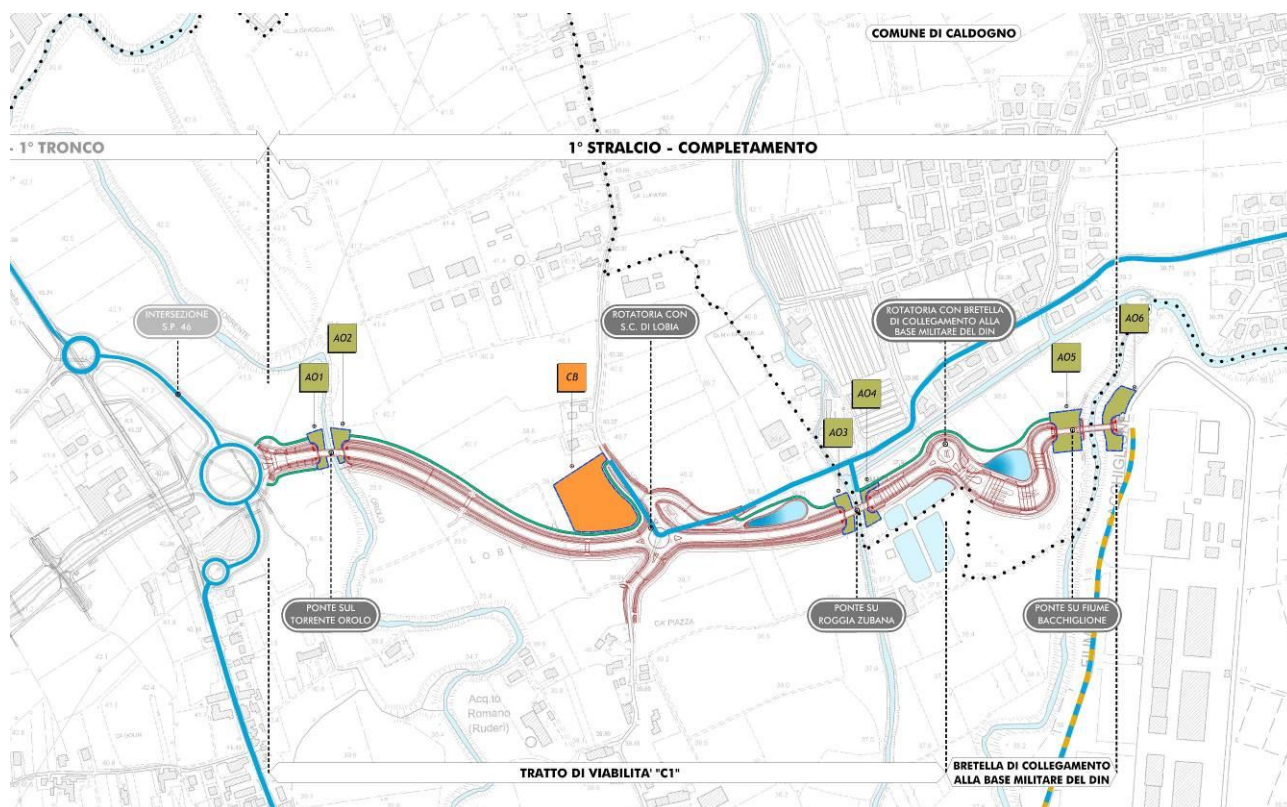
PLANIMETRIA CON INDICAZIONI DEI CANTIERI E VIABILITÀ DI SERVIZIO (ESTRATTO DALL'ELAB. T00CA00CANPE01)
